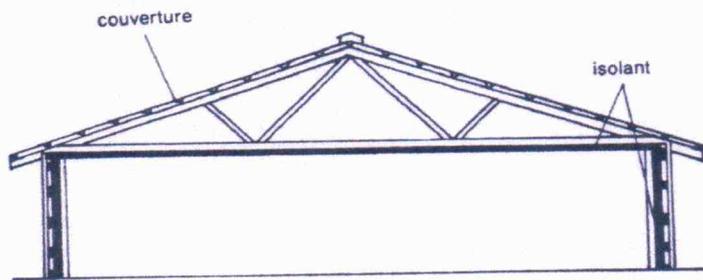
Isolation au niveau du faux plafond (ITAVI, 1983).
